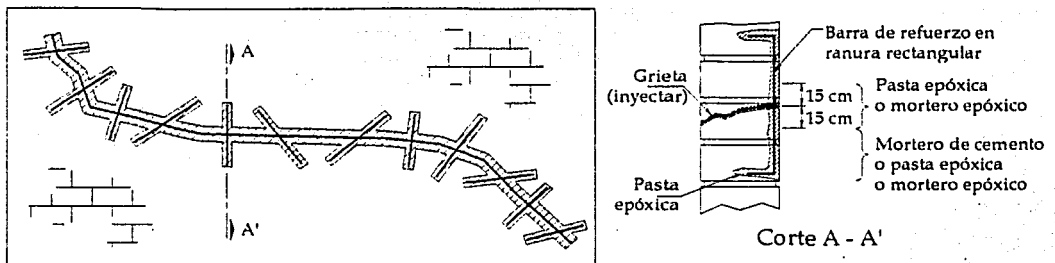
Colocación de grapas sobre grietas en muros de mampostería.
